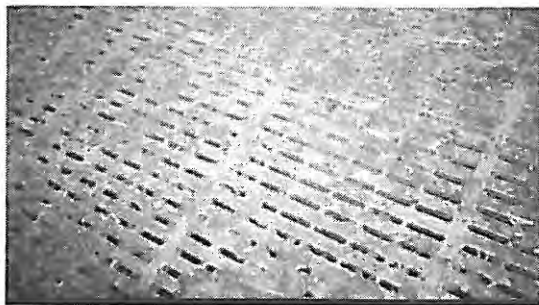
Betongspalt, 18 mm öppning (slaktsvinsspalt).
